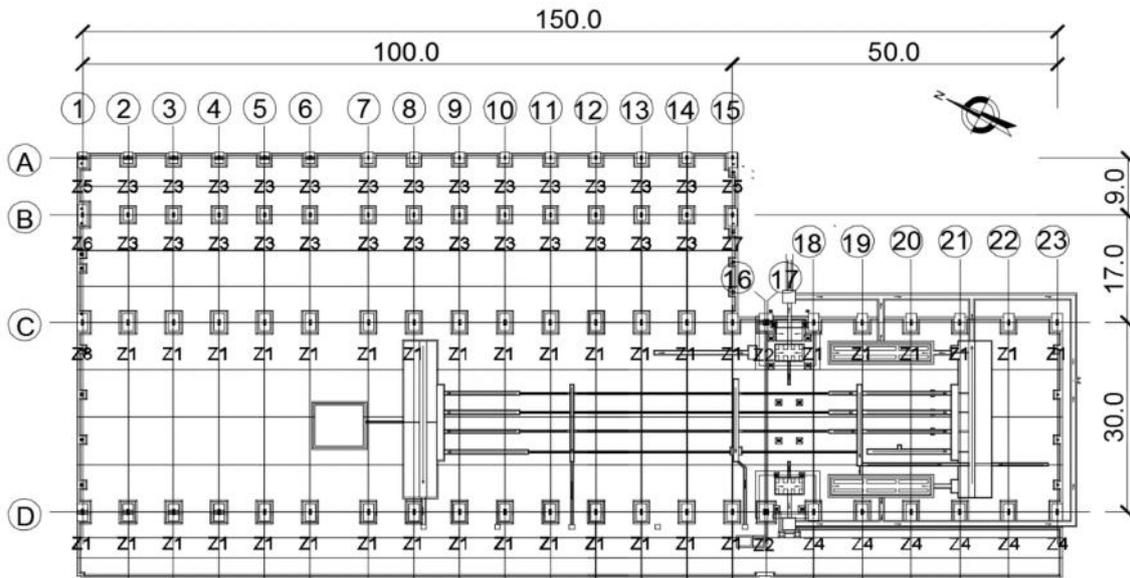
Distribución de Los pernos y plancha base de columna prefabricada
